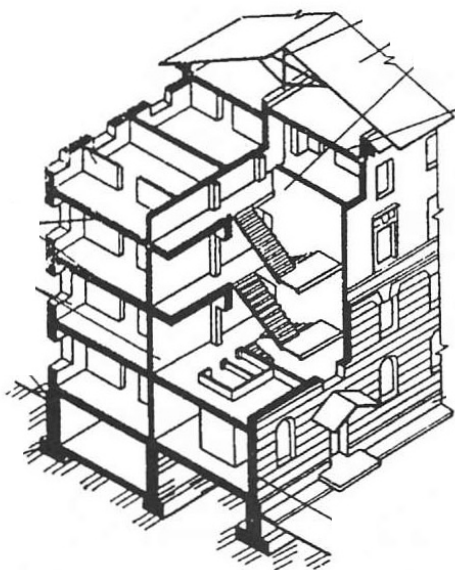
Трехэтажное здание с прямоугольными прогонами и с перекрытиями по деревянным балкам
